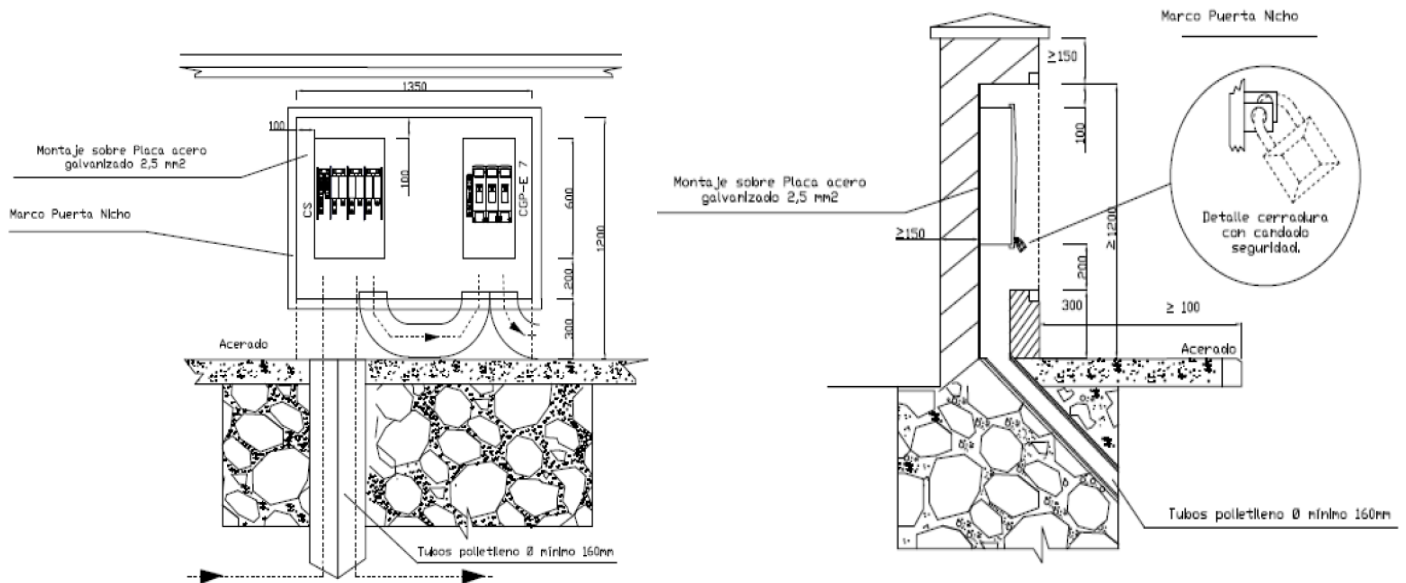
Detalle de la instalación de las cajas generales de protección. Fuente. NRZ 103, figuras 6 y 8.
